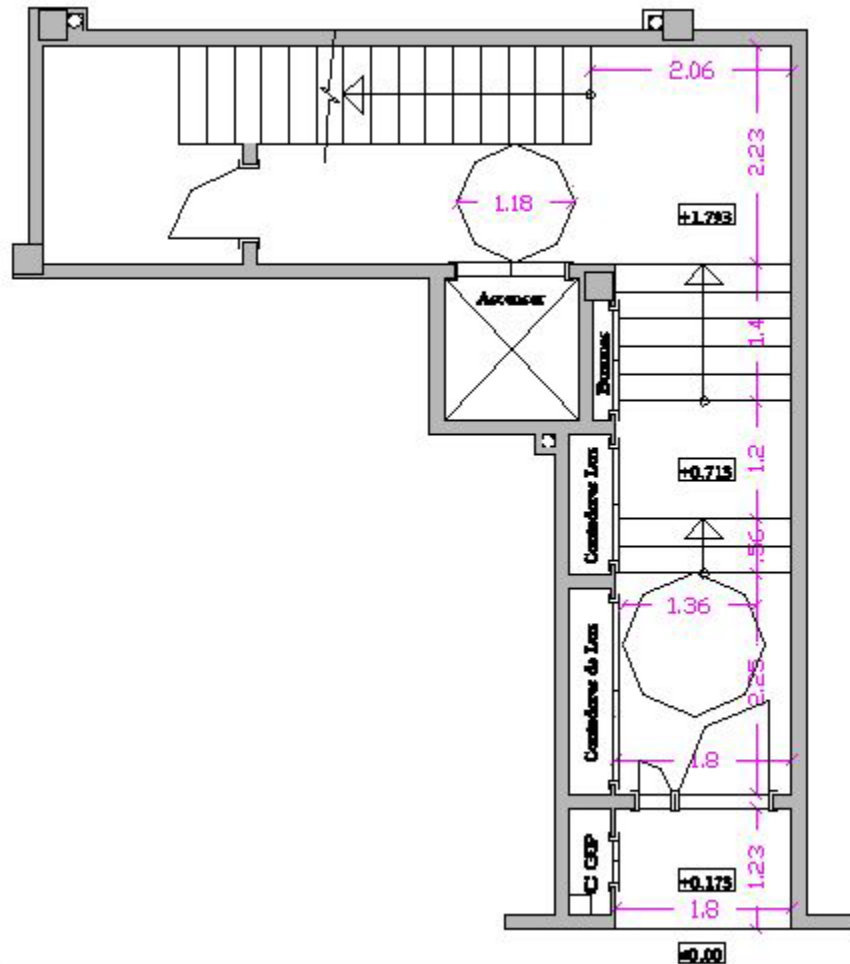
Accesibilidad, planta [Anexo II. Planos]
